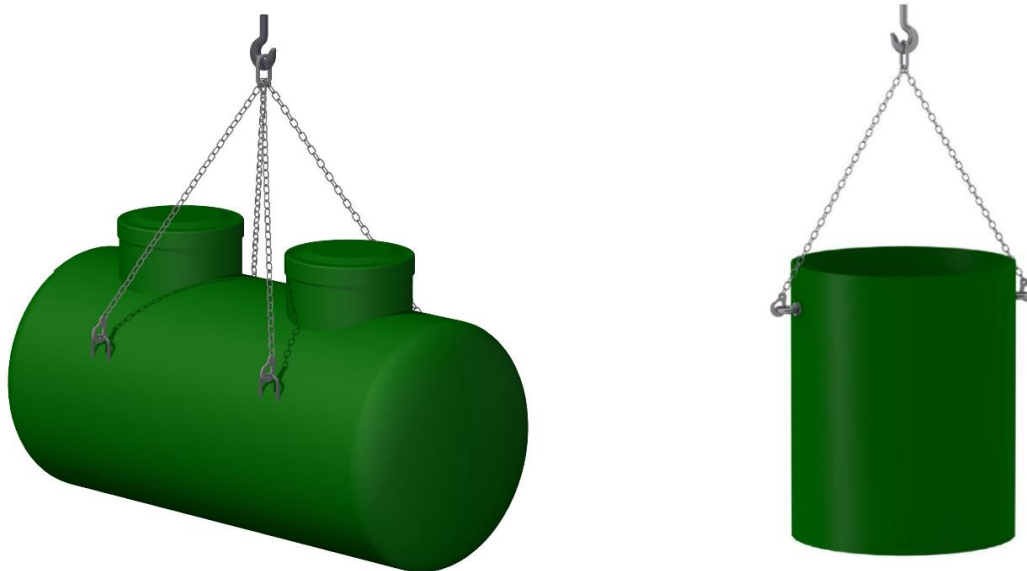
Метод строповки стеклопластиковых корпусов изделий
